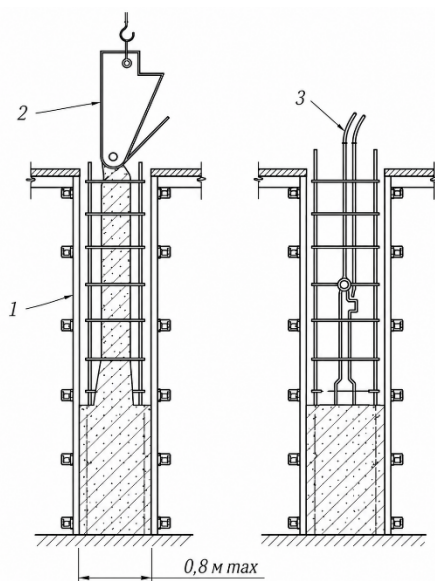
Схема бетонування колон: 1 — опалубка; 2 — баддя; 3 — вібратор з гнучким валом
